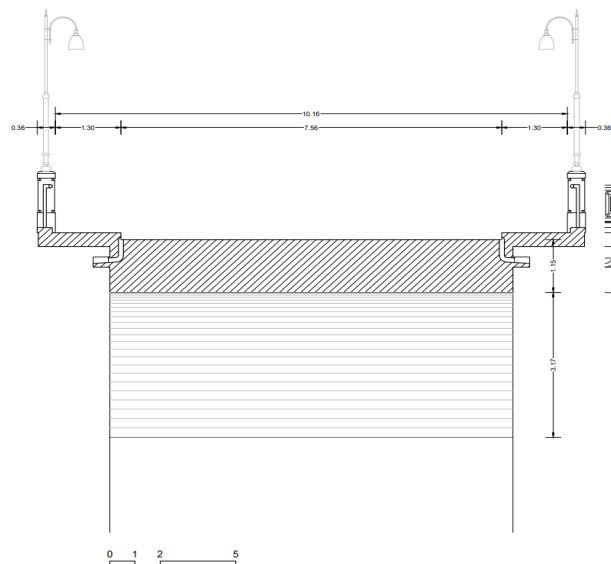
Sezione A-A trasversale del ponte e larghezza marciapiedi
